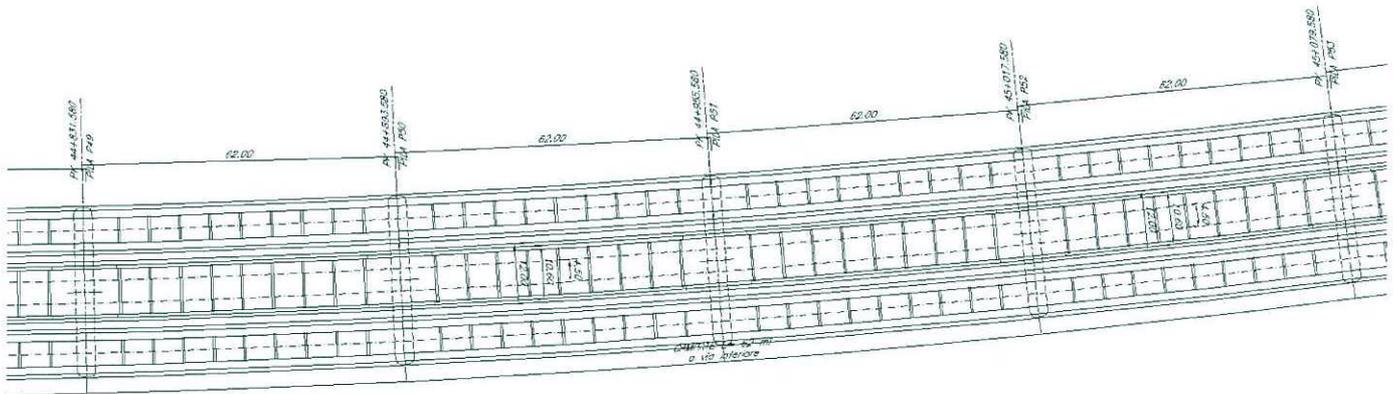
Pianta impalcato in corrispondenza dell'attraversamento dell'Isonzo.
